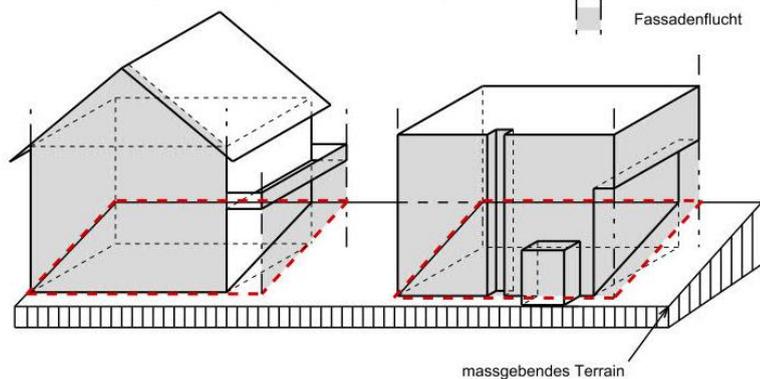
Figur 3.1 bis 3.3 Fassadenflucht und Fassadenlinie, IVHB
